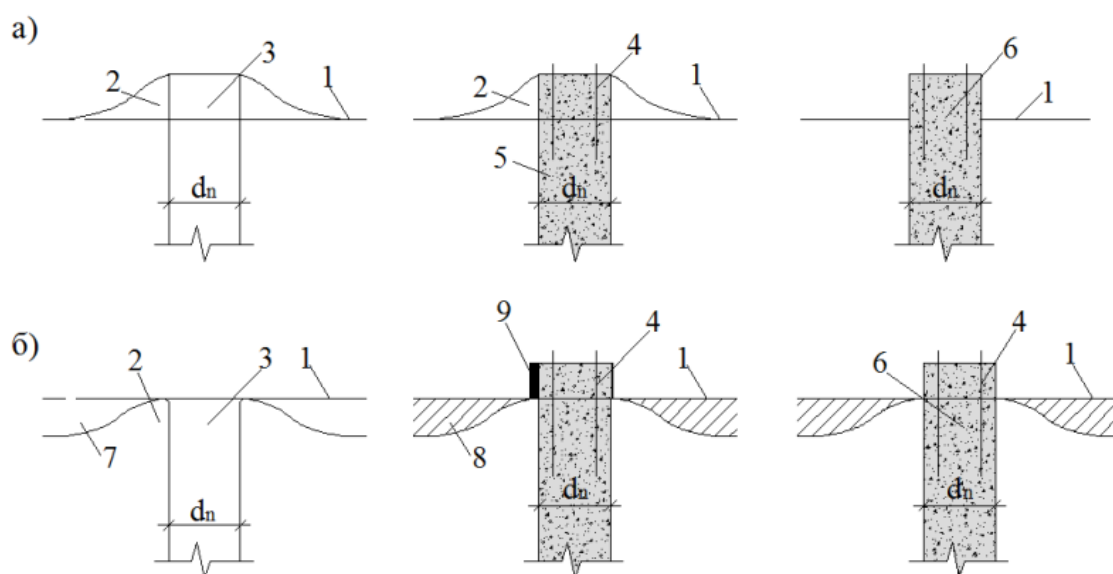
Схемы обеспечения проектной отметки дна котлована: 1- проектная отметка дна котлована; 2- выпор грунта; 3- оголовок НРС; 4- выпуска арматуры; 5- бетон; 6 – готовая свая; 7- перекоп котлована; 8 – выравнивающая уплотненная грунтовая подсыпка; 9- опалубка.
